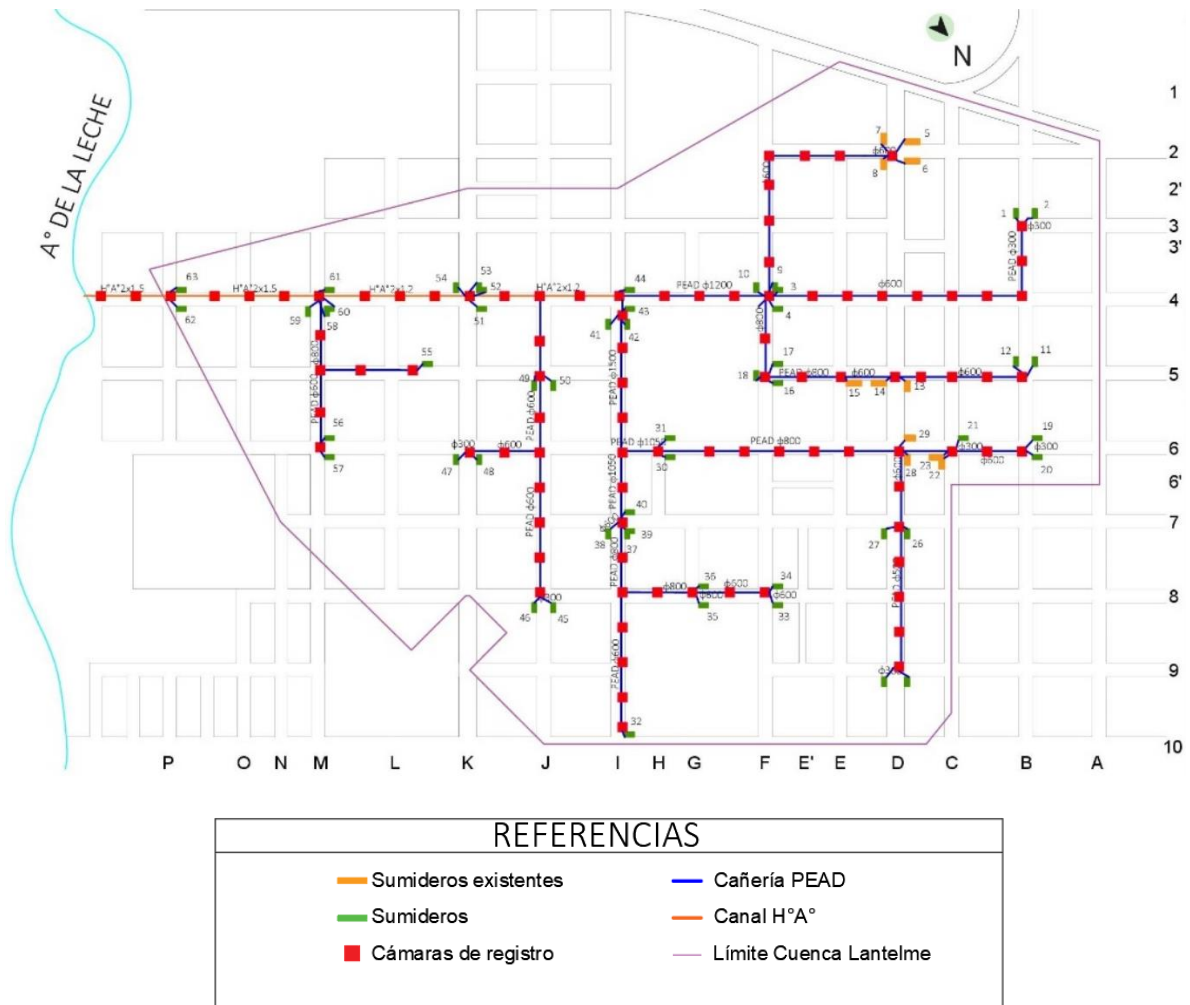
Bocas de tormenta, estructuras de alejamiento y cámaras de captación
